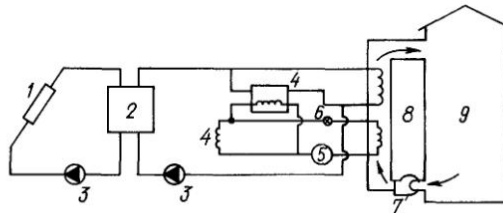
Схема комбинированной гелиотеплонасосной системы отопления здания с использованием теплового насоса с двумя испарителями
